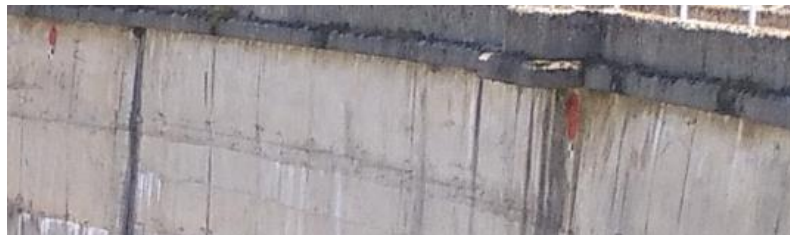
Detalle de las dianas de puntería (en rojo).
